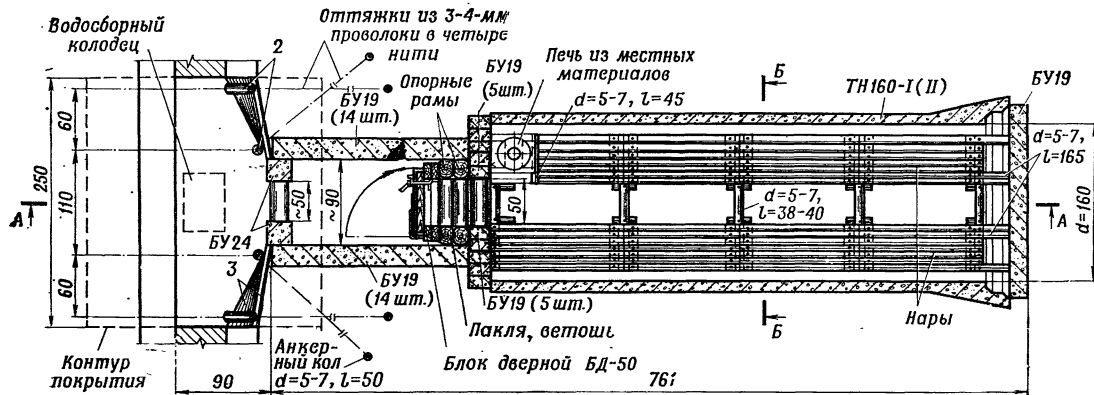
Блиндаж из железобетонной трубы и перемычек (план, разрез)
